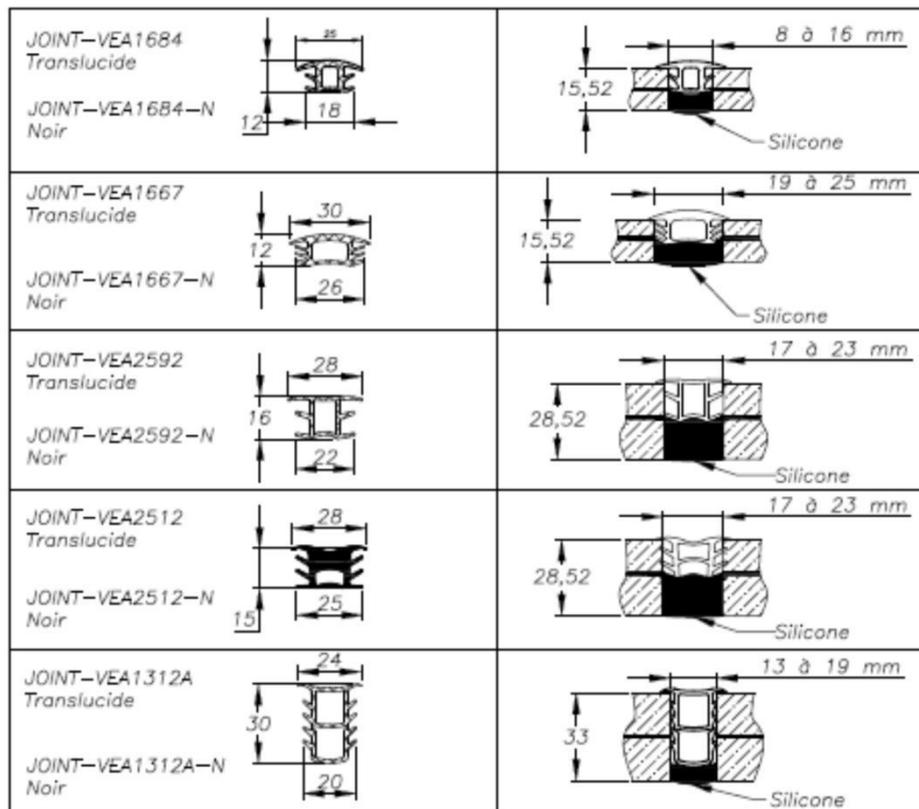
Exemple de profilés d'étanchéité entre vitrage
